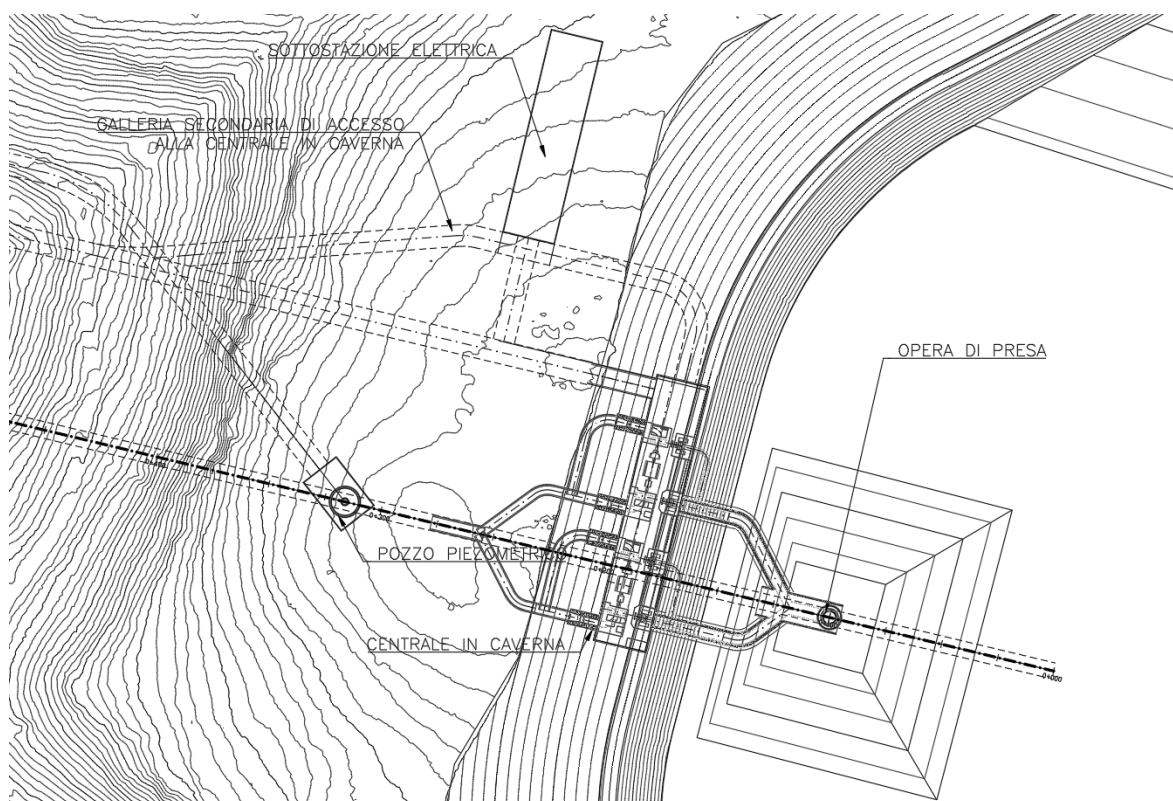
Planimetria della galleria di accesso alle caverne nel tratto di arrivo
